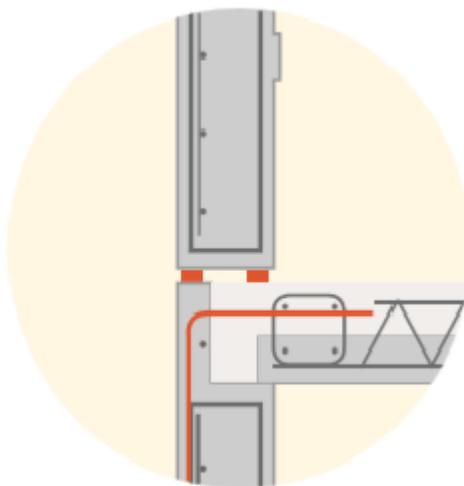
Unión Muro- Losa Fuente: Baumax
